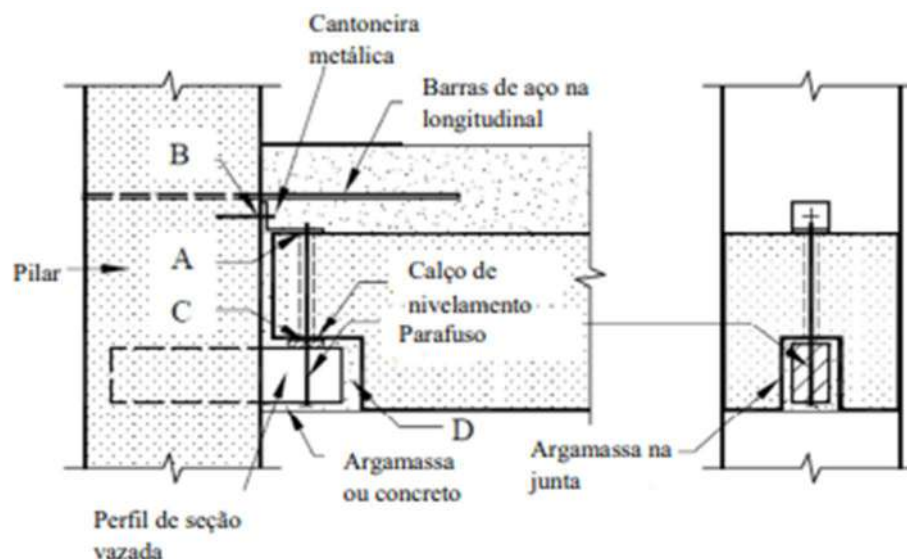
Modelo de ligação viga-pilar com consolo metálico embutido de seção laminada
